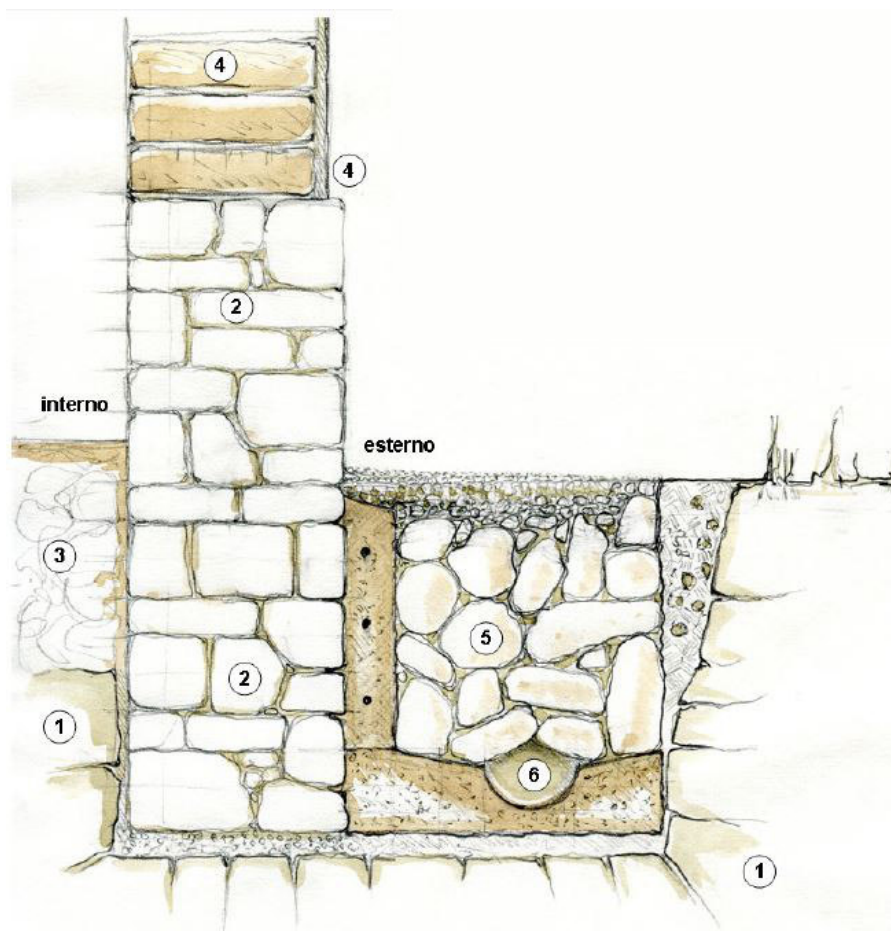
1.sezione del terreno naturale; 2.apparato di fondazione e basamento in pietrame; 3.pacchetto pavimento; 4.muratura in adobe e particolare costruttivo tradizionale da risanare; 5.sistema di risanamento e drenaggio delle fondazioni esterne; 6.canale di scolo sotterraneo dell'acqua piovana e di infiltrazione laterale. - Disegno autografo dell'arch. Alceo Vado, appositamente autorizzato per questa pubblicazione
